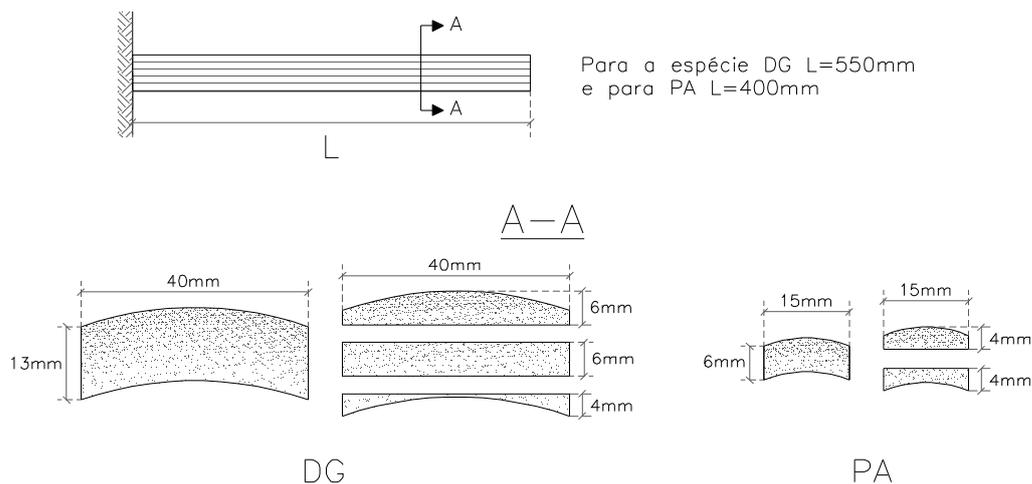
Comprimento e seções transversais dos segmentos de bambu
